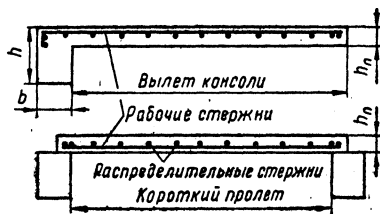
Армирование консольной и однопролетной плит сварными сетками.
